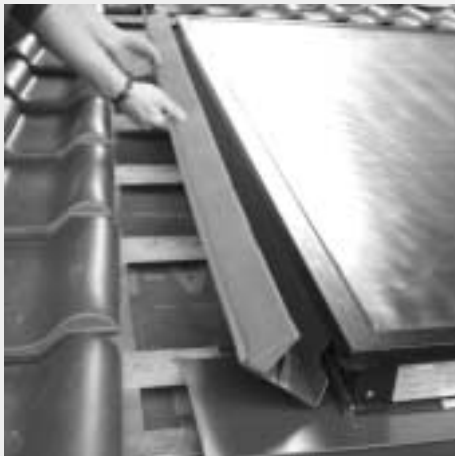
Tôle de couverture latérale insérée, à gauche
